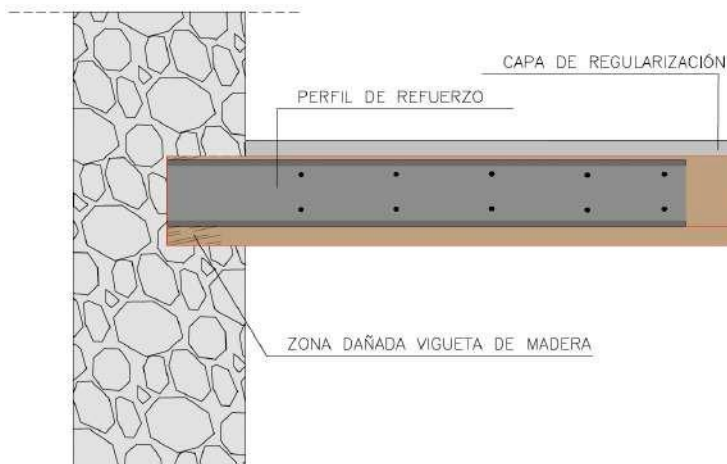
Refuerzo de perfil metálico en caras laterales de la cabeza de la vigueta. Fuente propia
